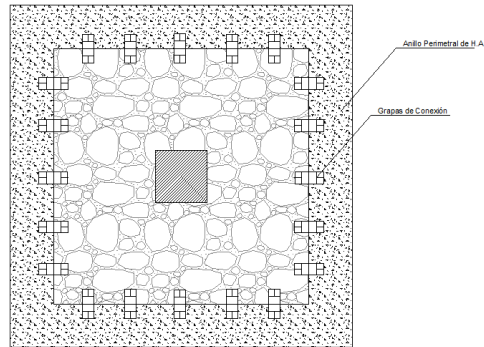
Planta de zapata reforzada. 2010. Rehabilitar con Acero
